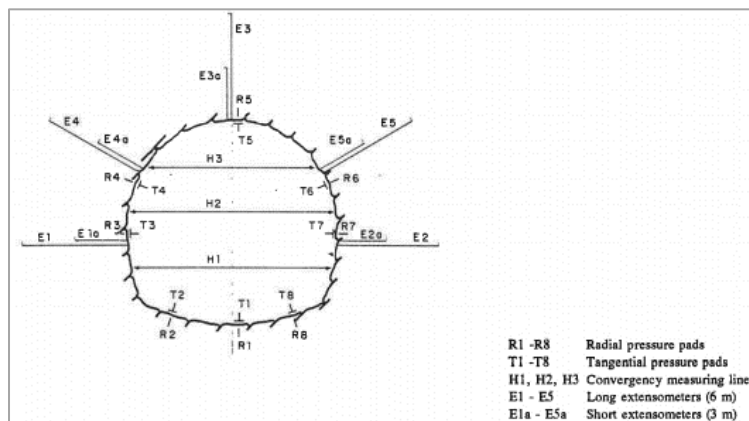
Ejemplo de instrumentación instalada en un túnel. Fuente: (Palmström, 1993)
